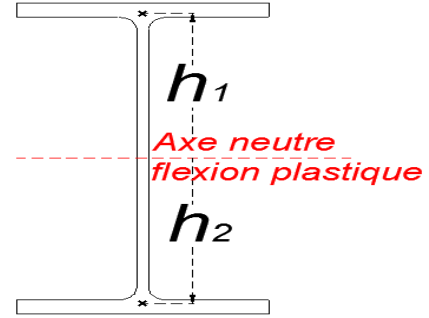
Position de l'axe neutre pour la section de la poutre w410x46
